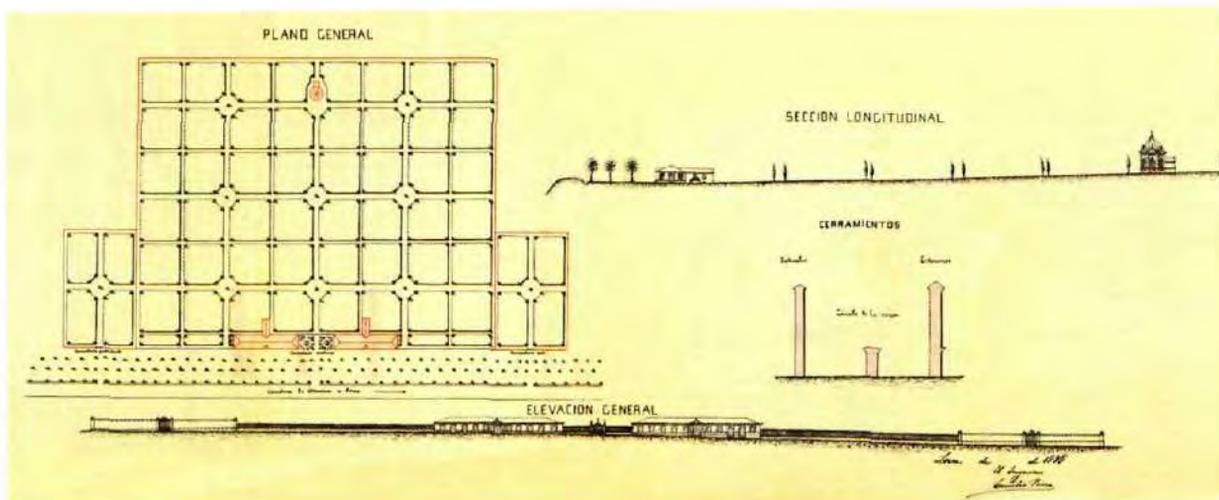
Plano general, sección longitudinal y cerramientos del cementerio. Ingeniero Riera. 1888
